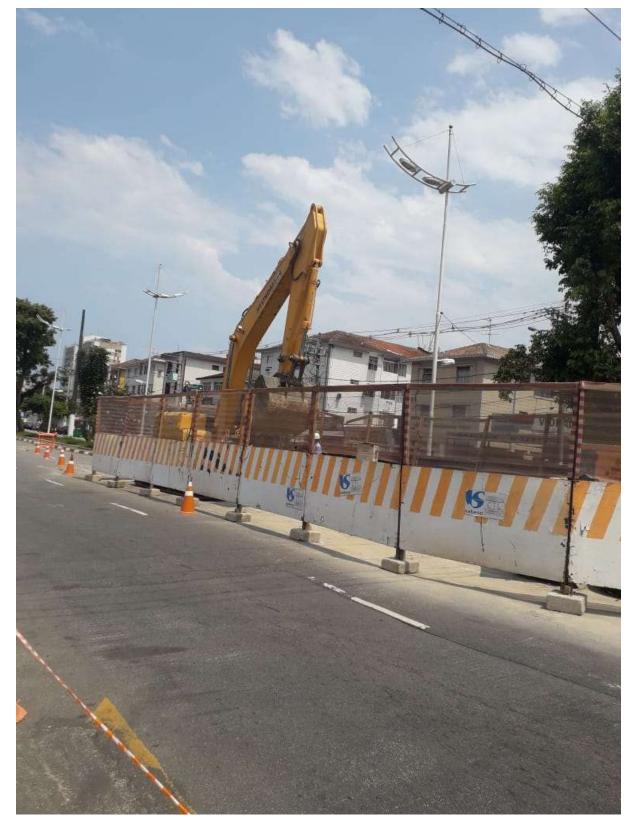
Canteiro de obras da Avenida Afonso Pena em detalhe
